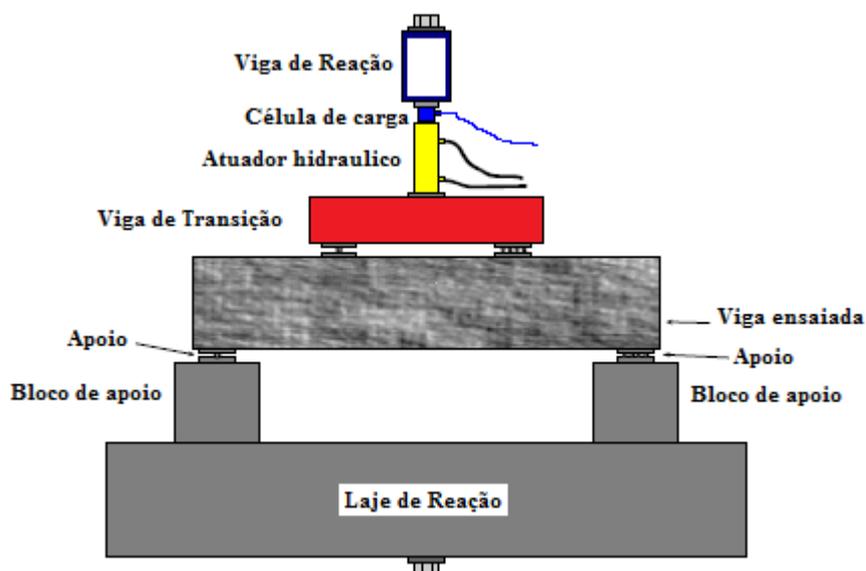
Esquema estático do ensaio – Pórtico de Reação
